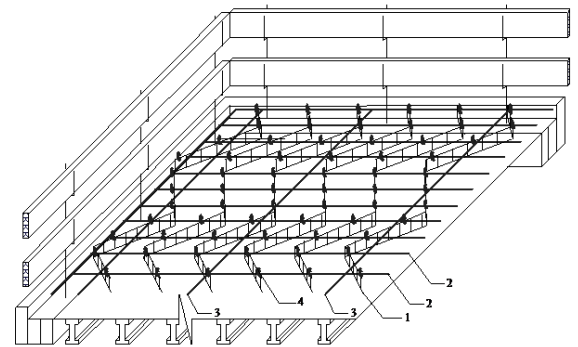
Улаштування арматурної сітки: 1 - стрижні арматурної сітки; 2 - підтримуючі каркаси; 2 - поперечні каркаси; 3 - закріплення арматурні стержні верхньої сітки, підтримуючого каркаса до укладені з проектним кроком; 3 - арматурної сітки в'язанням дротом; 4 - закріплення верхніх поперечних стрижнів до підтримуючих каркасів за допомогою в'язального дроту
